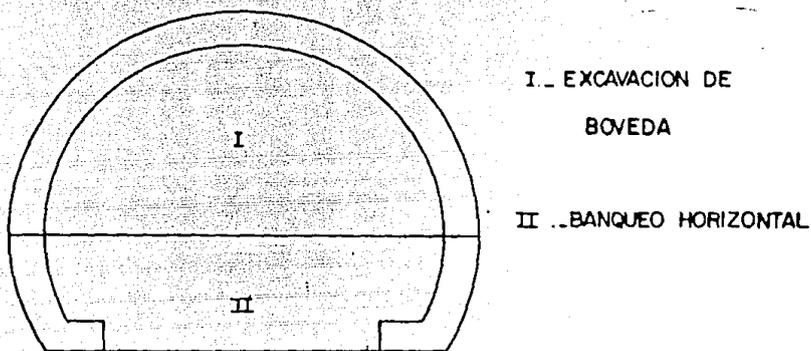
CORTE TRANSVERSAL (ALTERNATIVA II)
